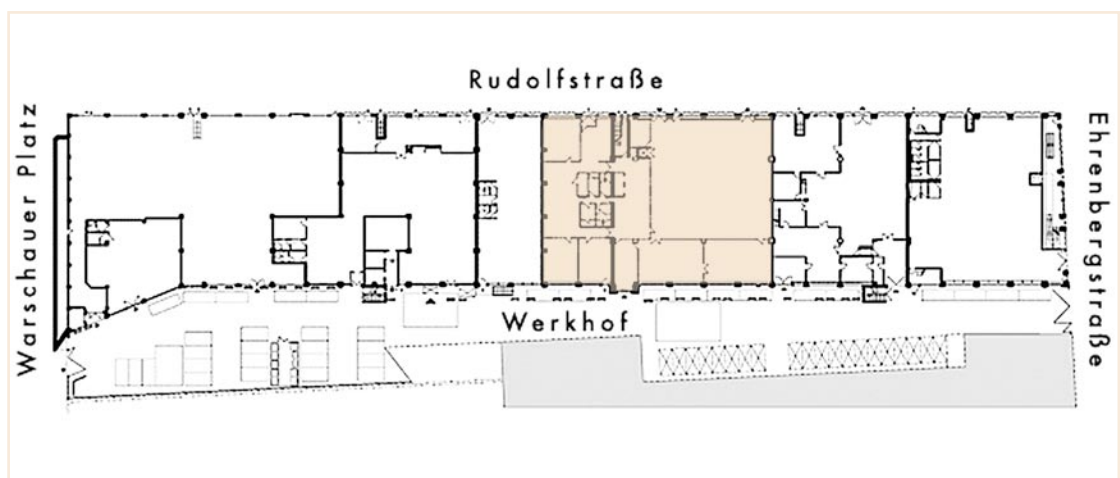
Der Grundriss der Rudolphhalle
